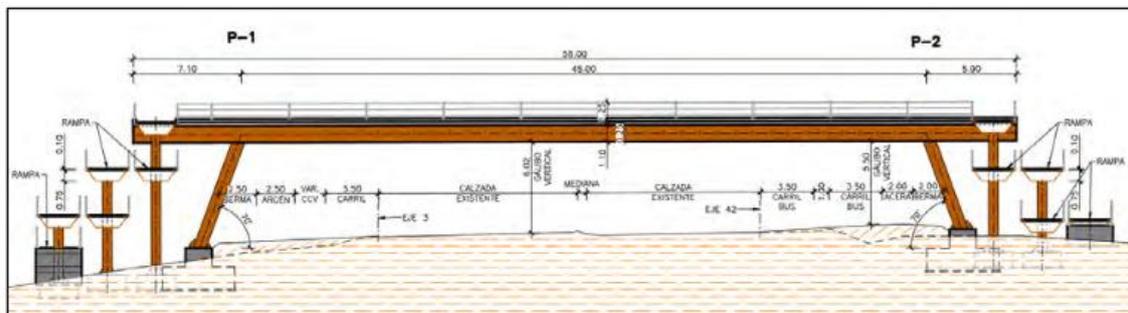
Alzado longitudinal de tramo de cruce PAS 9+090
